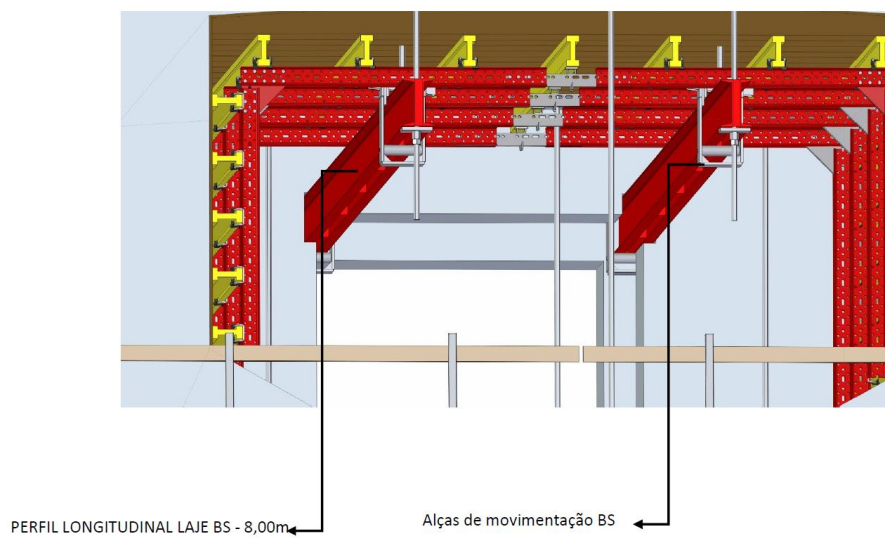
Setas indicando Perfil Longitudinal Laje
